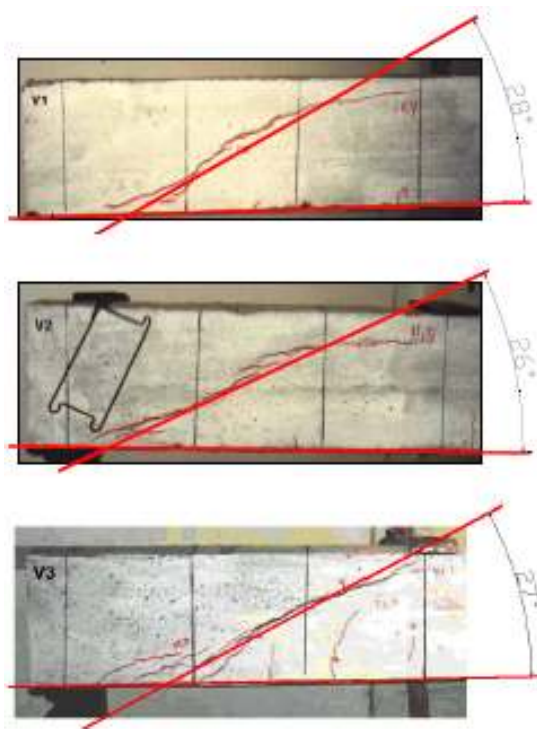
Medição dos ângulos das fissuras diagonais (CARELLI, 2002)
